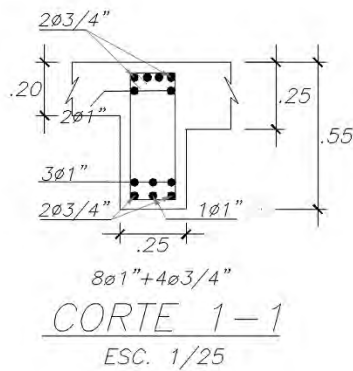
Detalle Corte 1-1 de Viga VP-06
